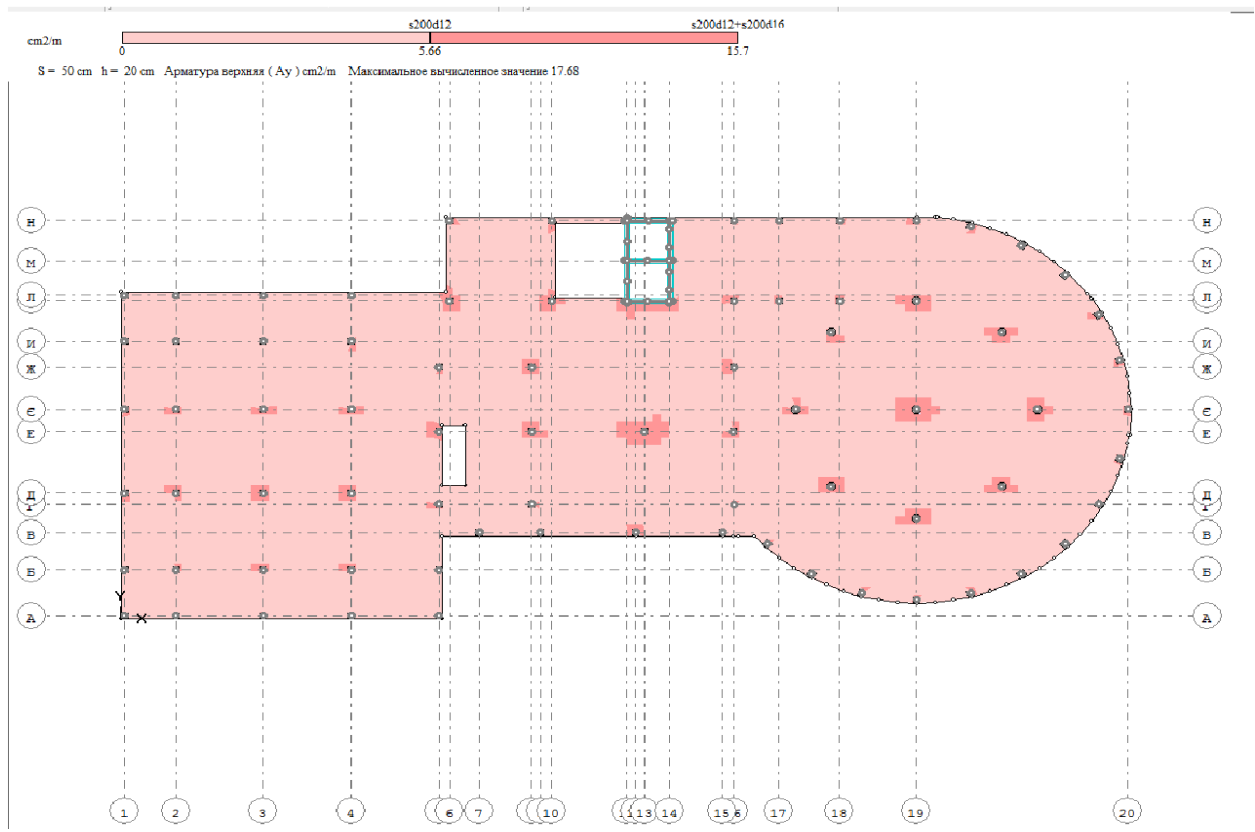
Армования плиты перекрытия верхне по оси У
